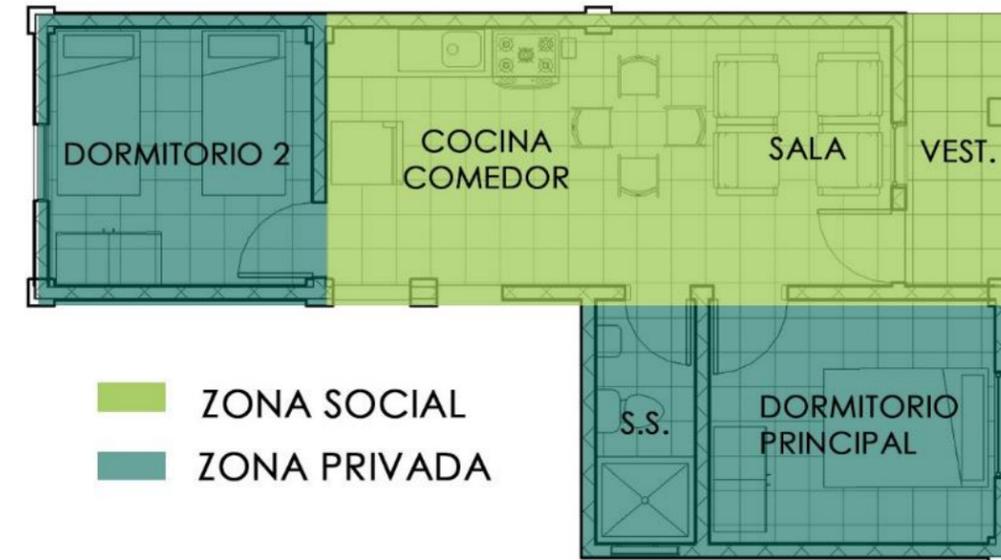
Planta Arquitectónica de zonificación de la vivienda Modelo propuesta por Masinfa / Holcim. Elaborado por las autoras a partir de planos proporcionados por Masinfa.
